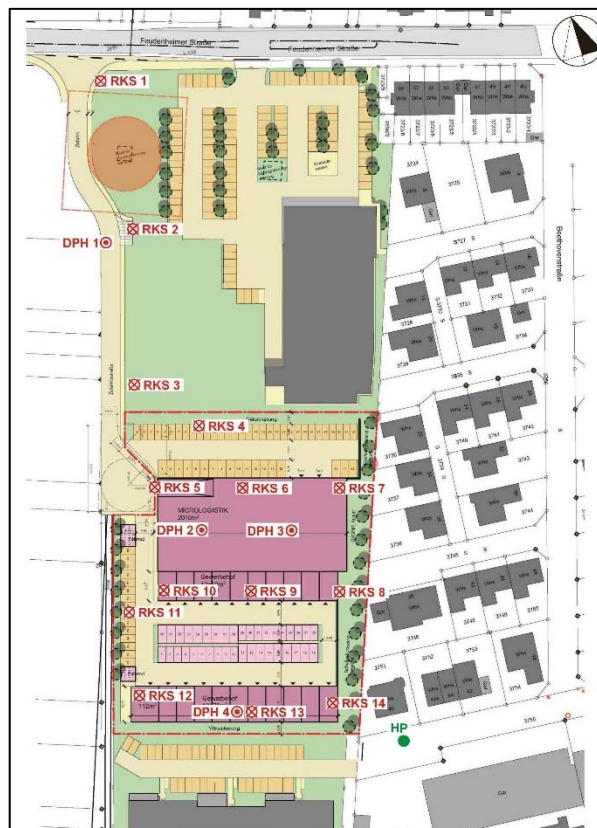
Lage der Baugrundaufschlüsse [U5]
